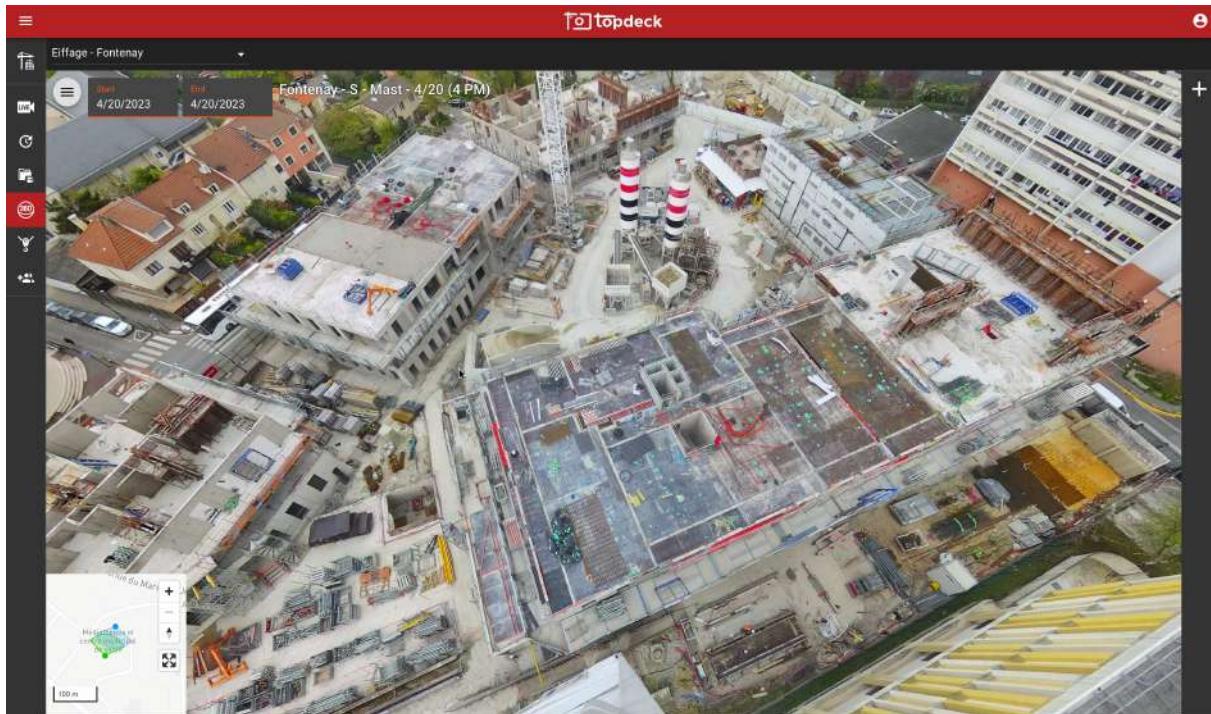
Plan d'installation de chantier du projet de logement à Fontenay
